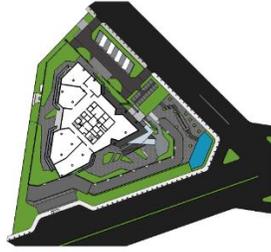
7 Denah Lantai Empat Podium / Refuge
